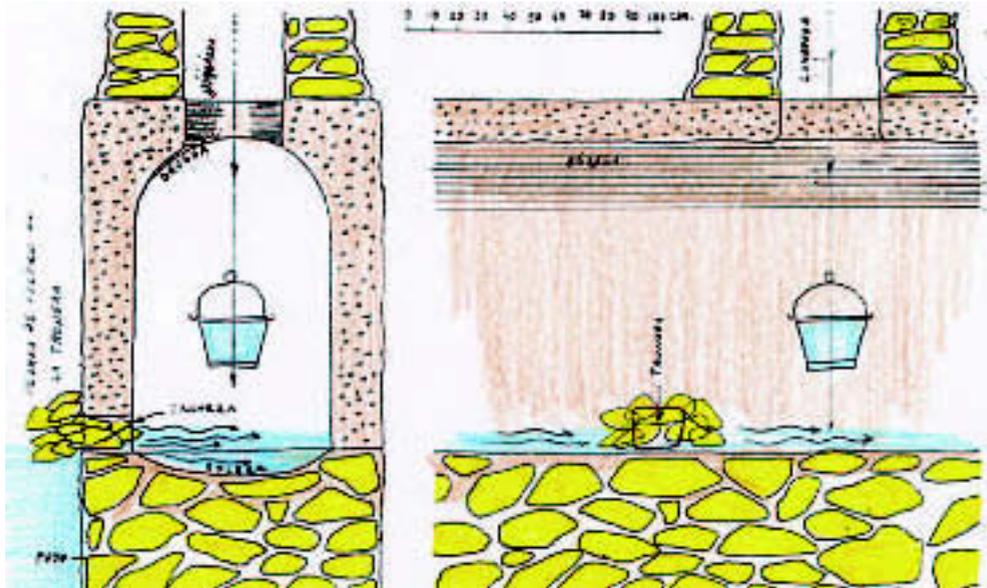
Sección del Contracaño. El agua accede al interior de la galería por troneras con filtro de piedra en seco.
